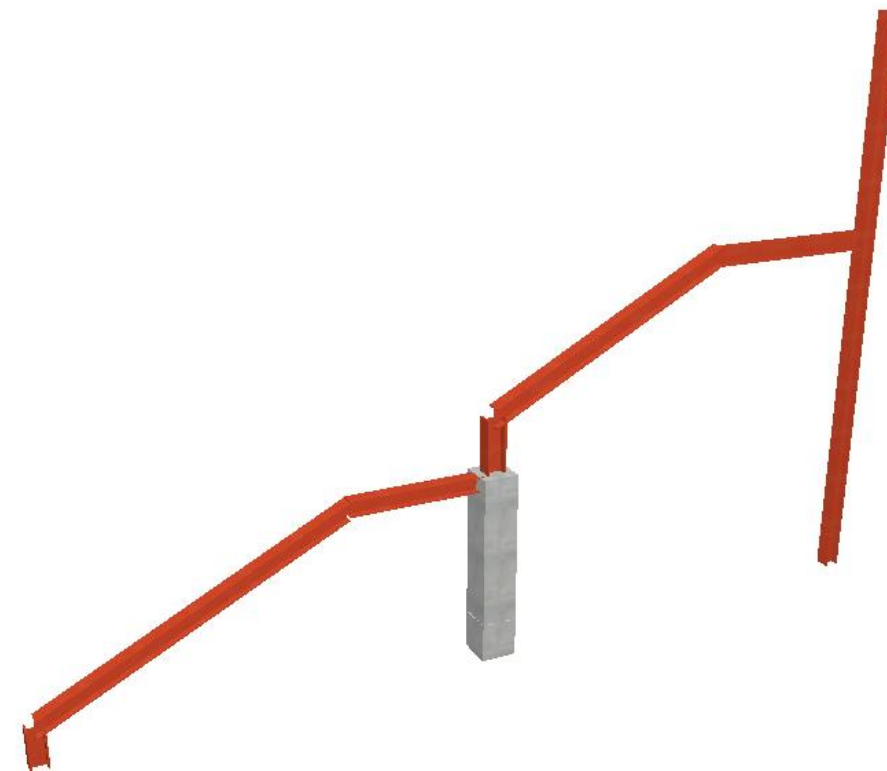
Pórtico tipo de la estructura de graderío. Fuente: Propia
